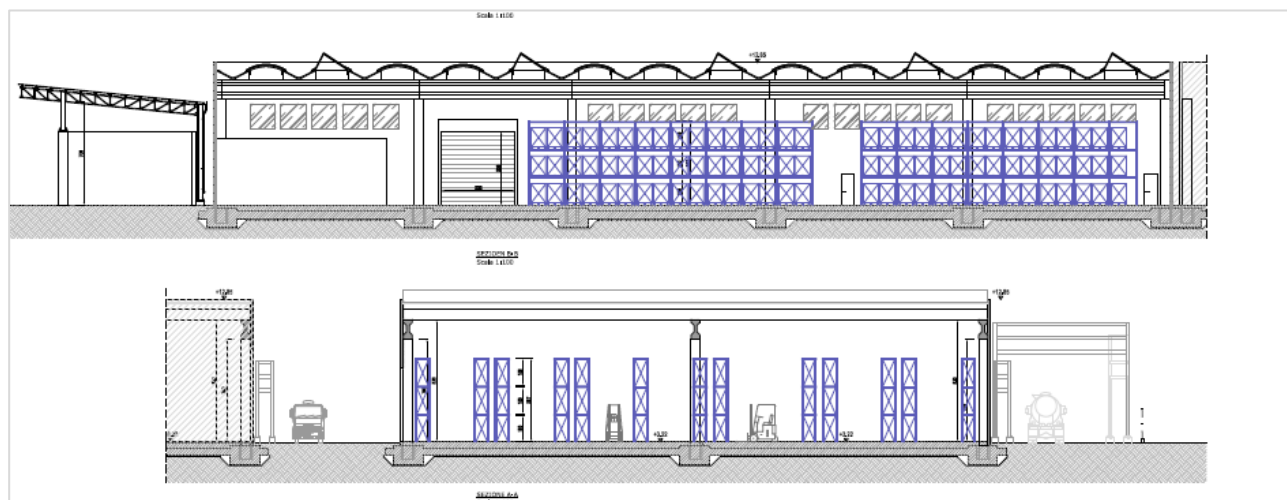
Prospetto B-B e A-A (Stralcio elaborato CO 05 RA VA 01 D1 PL 63.00 - N7 PROSPETTI E SEZIONI)
